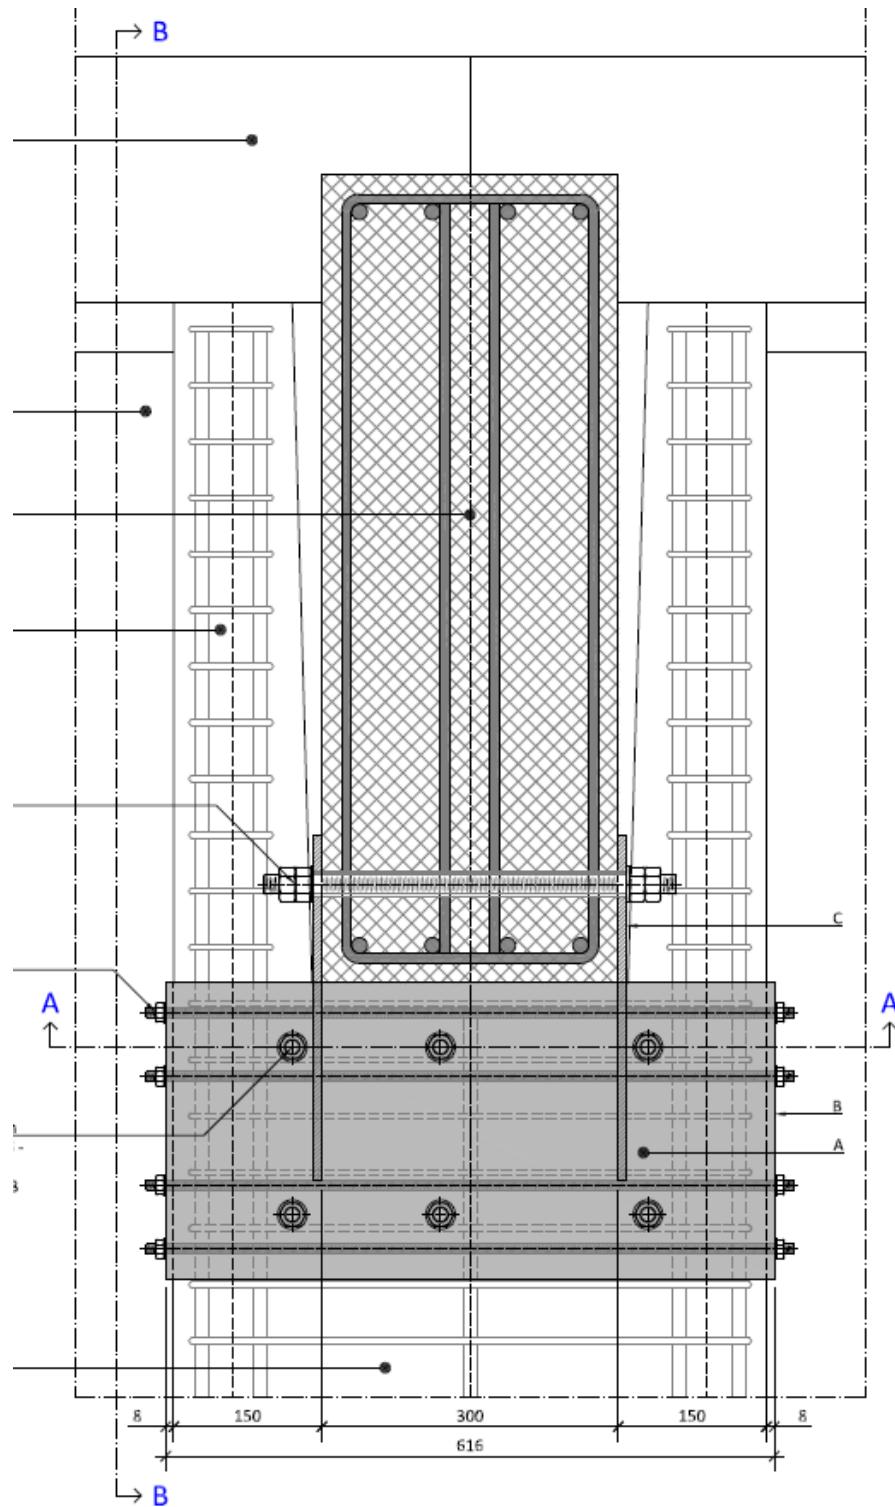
Intervento 02a – Sezione ortogonale al piano della trave
